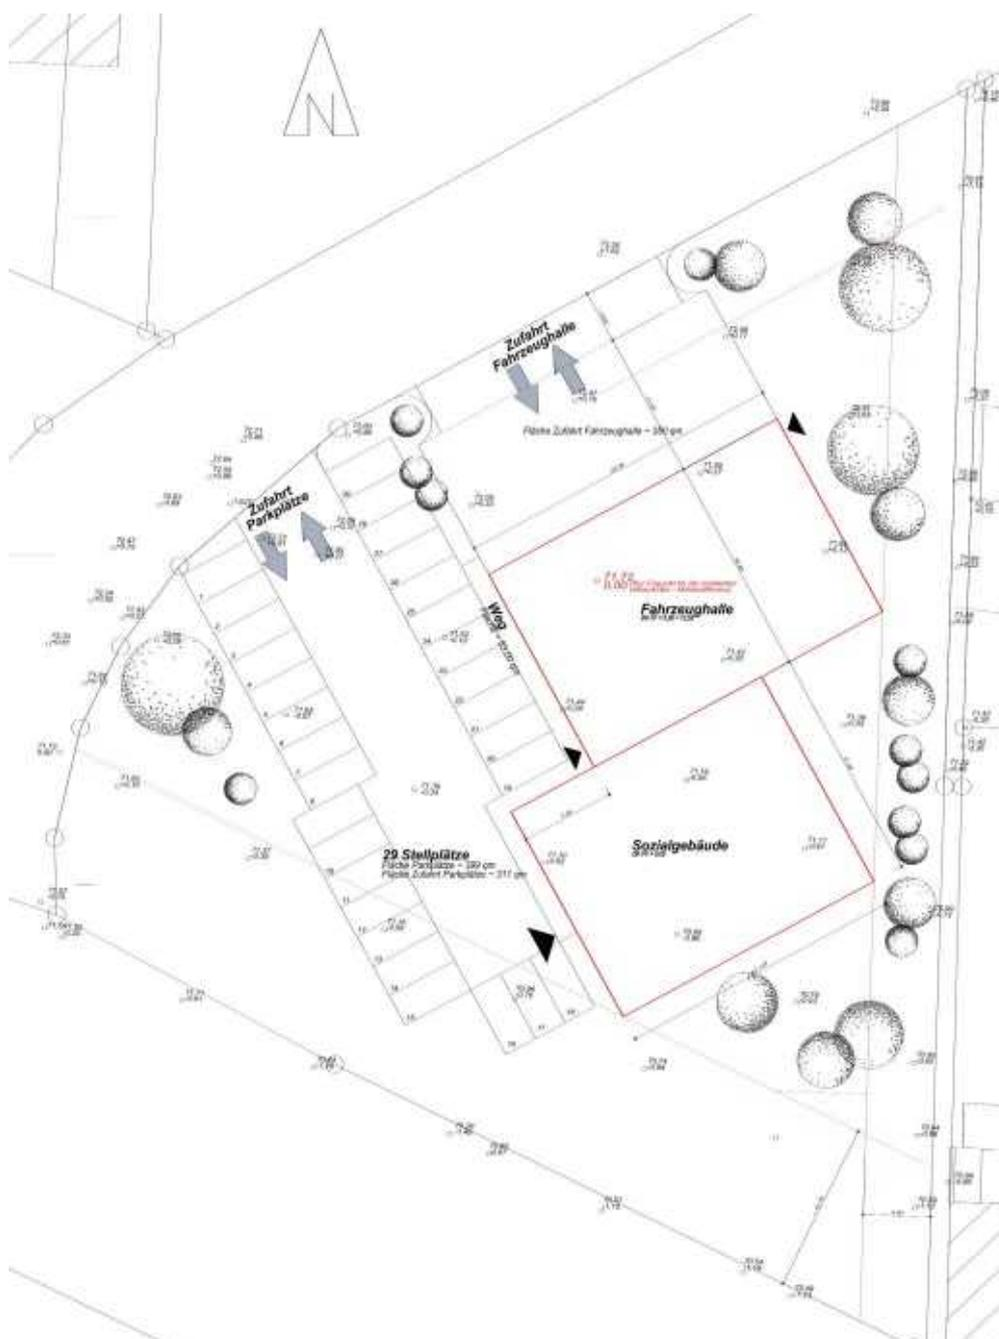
Vorentwurf, Lageplan geplantes Feuerwehrgrundstück, beschriftet mit: „Entwurf der Vorplanung vom 26.07.2016 (Variante 8)“
